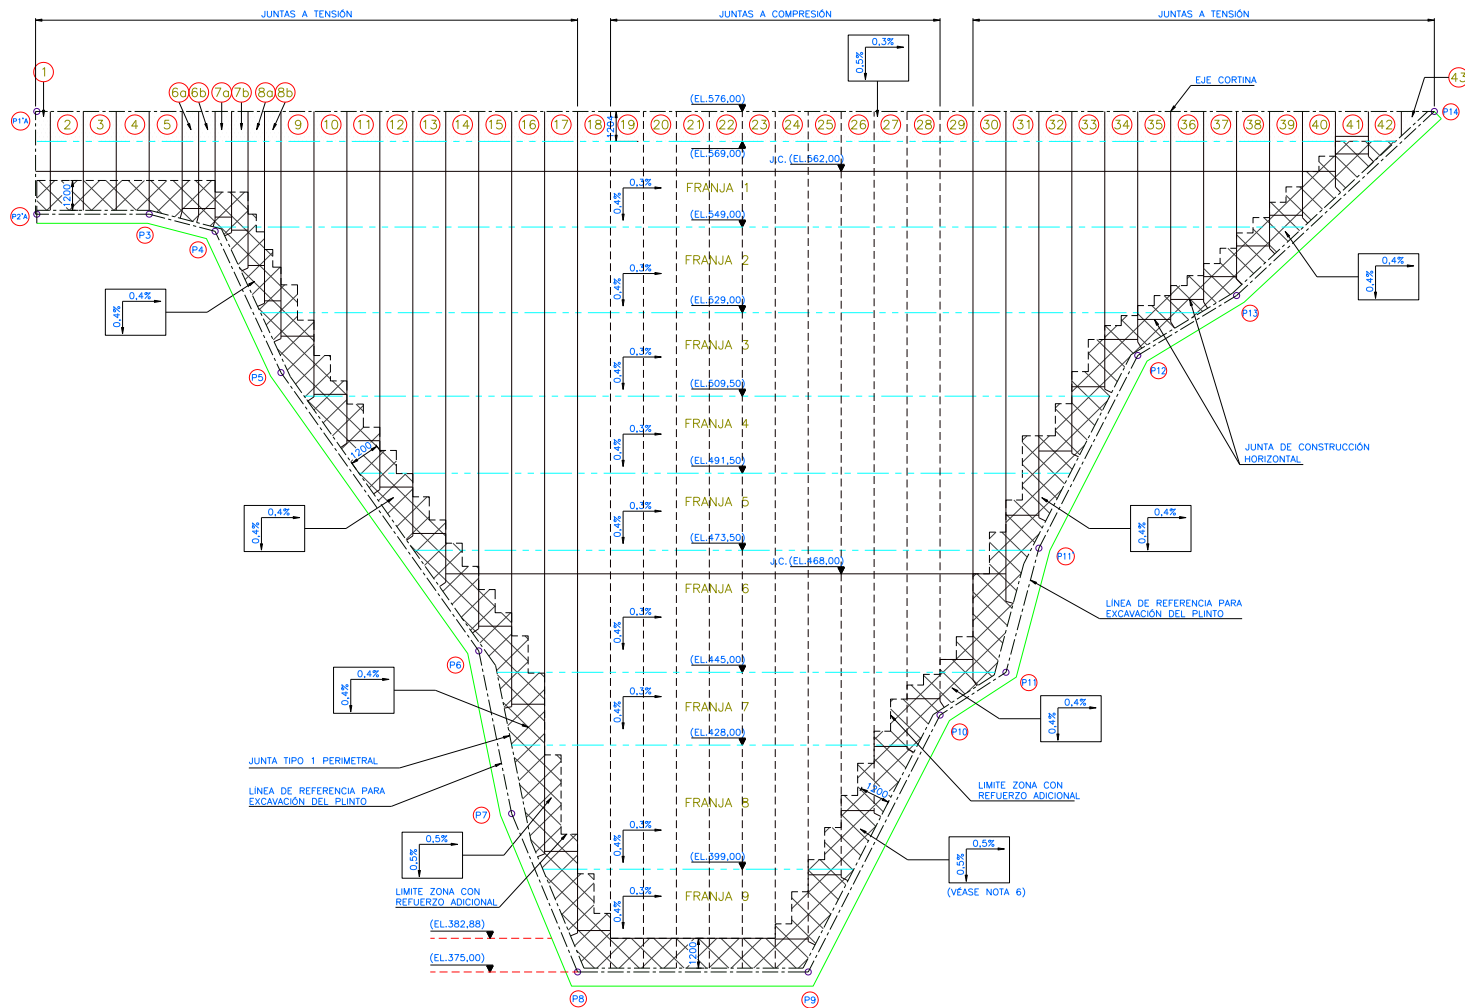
Refuerzo Cara de Concreto. Vista Normal
